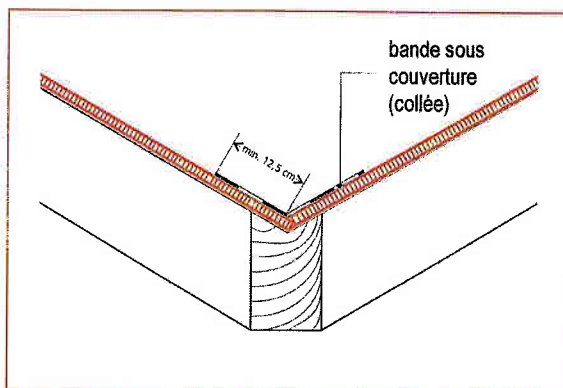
le joint de noue des panneaux Celit 4D est recouvert d'une étanchéité.
